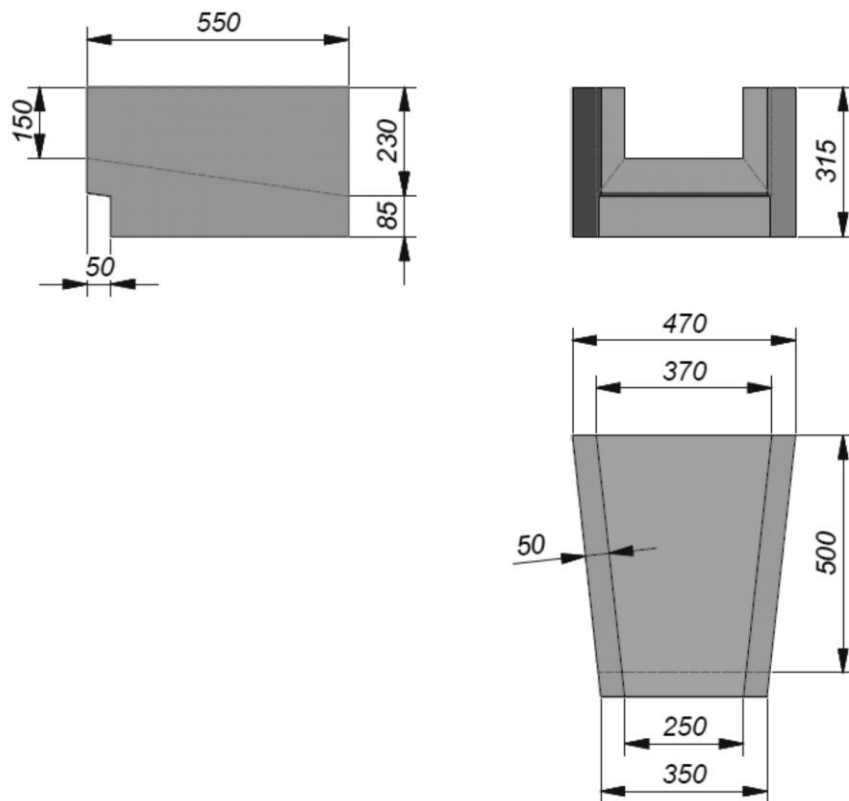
detail van de geprefabriceerde taludgoten van beton, type A (alle maten in mm)
